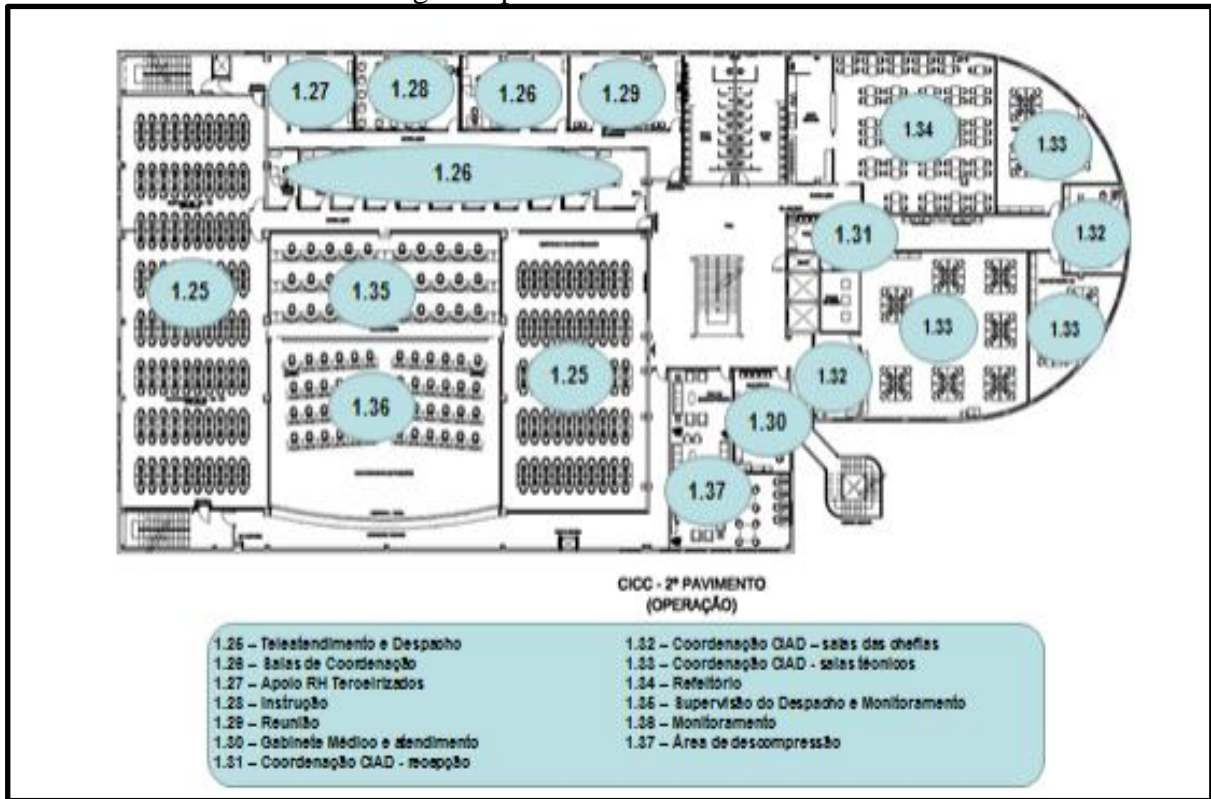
Planta baixa do pavimento técnico do CICC de Minas Gerais
